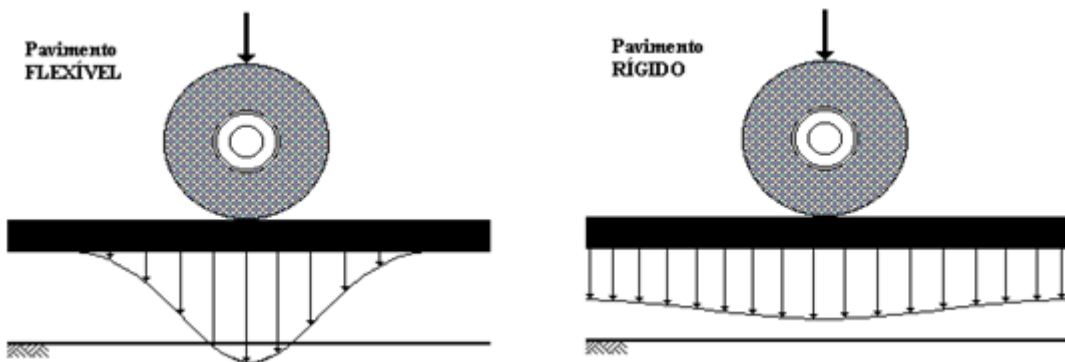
Diferença de Exposição às Cargas em Pavimento Flexível e Rígido (Fang, 2015)
